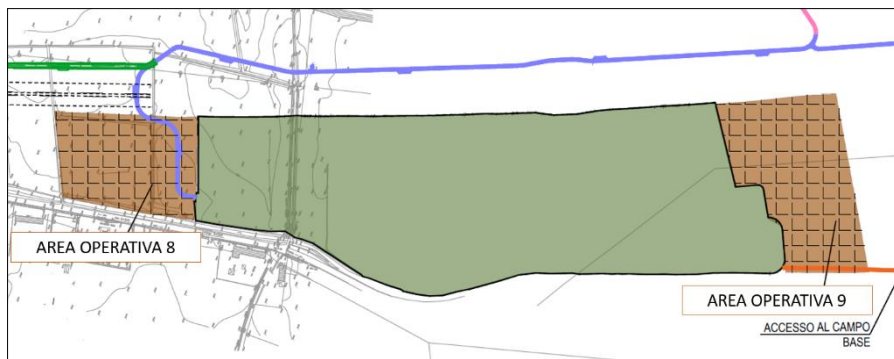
Stralcio planimetrico Aree Operative 8 e 9
